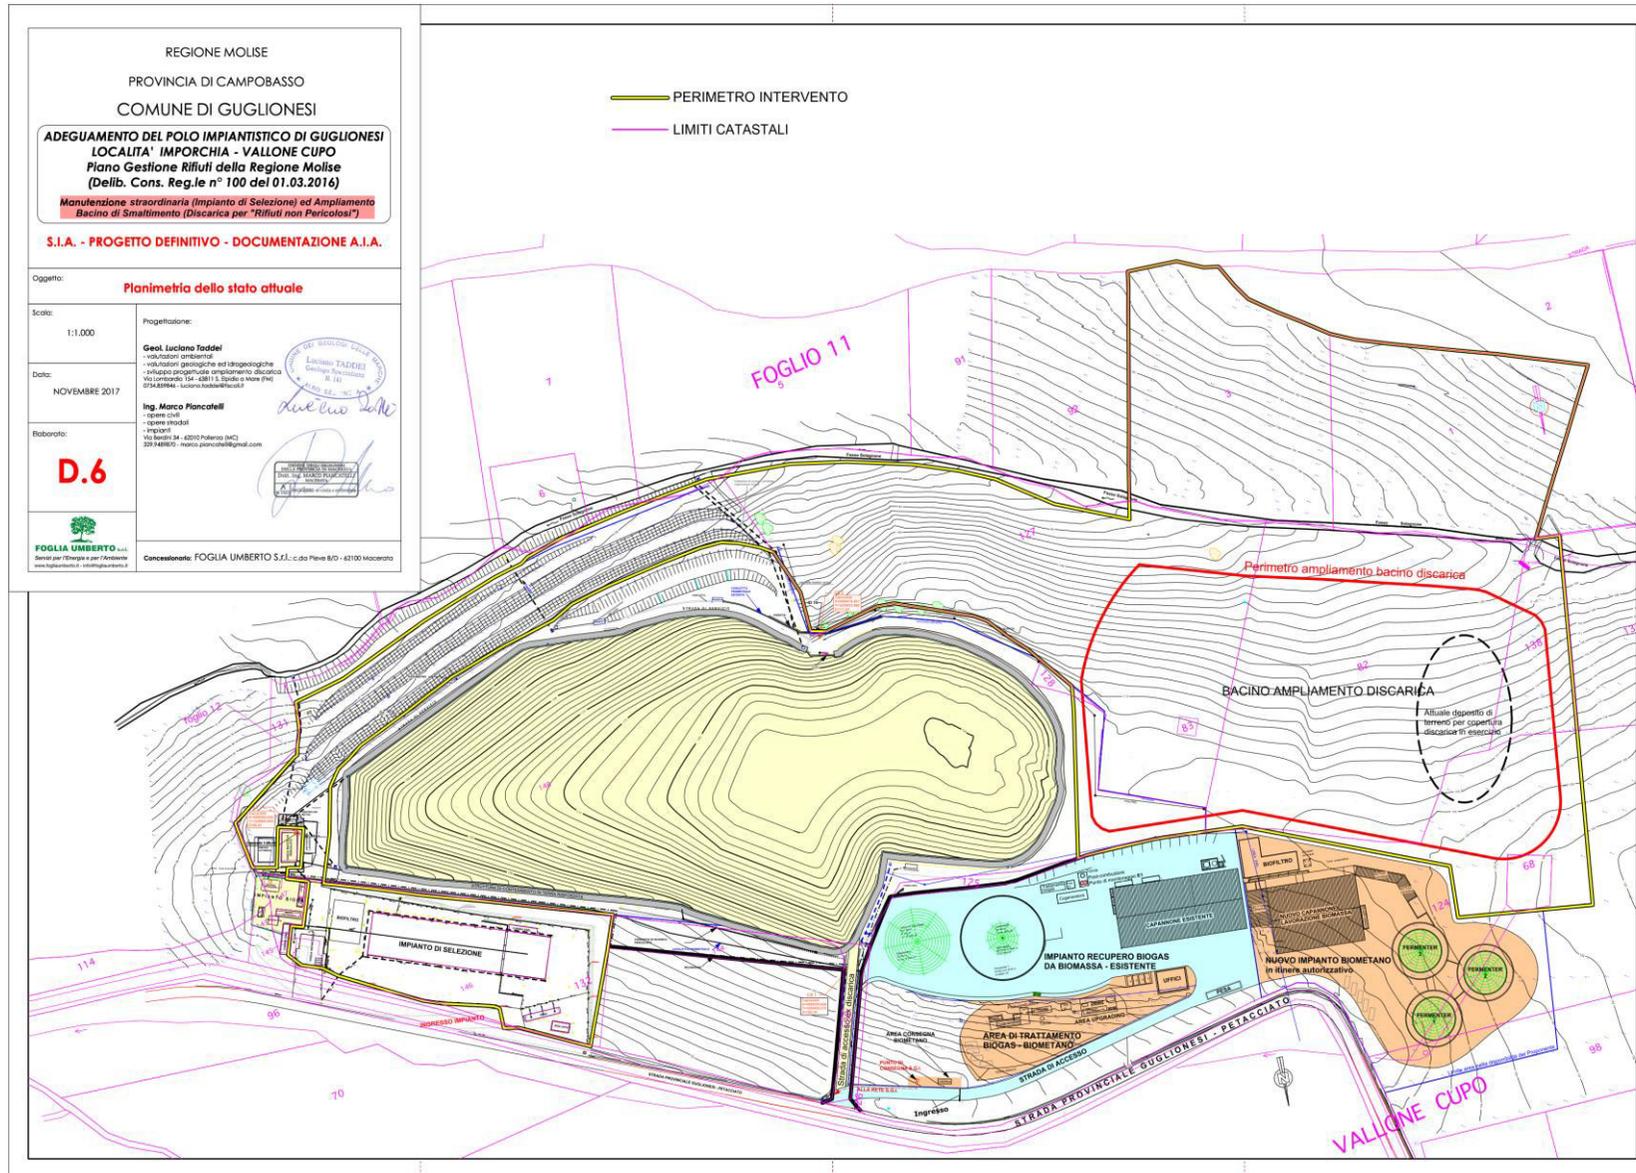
planimetria generale dell’installazione: assetto “ante operam”
